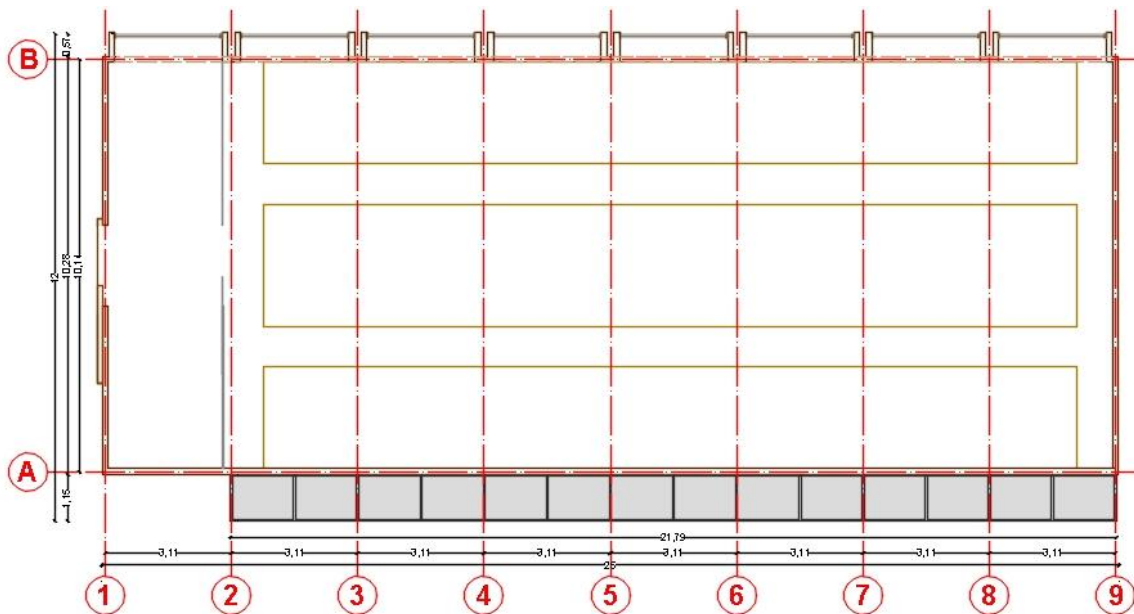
Planta arquitectónica del invernadero caso mejorado.
